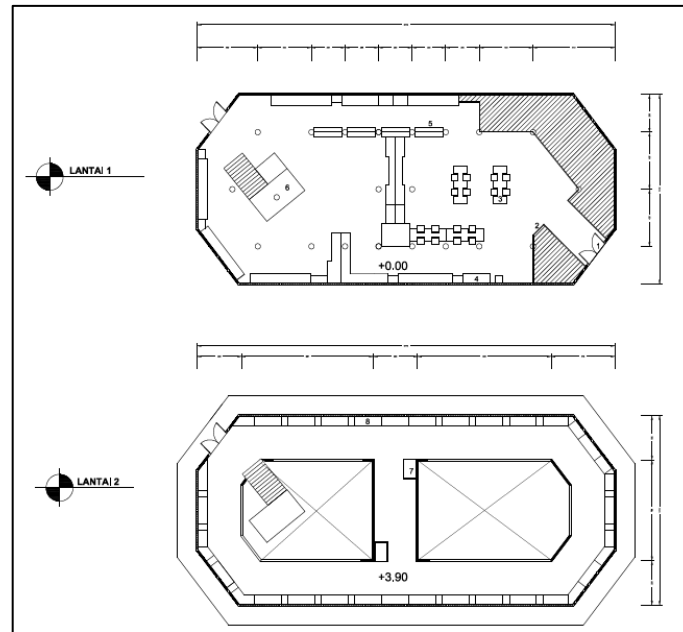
12 Alternatif 3 Denah Lantai 2
